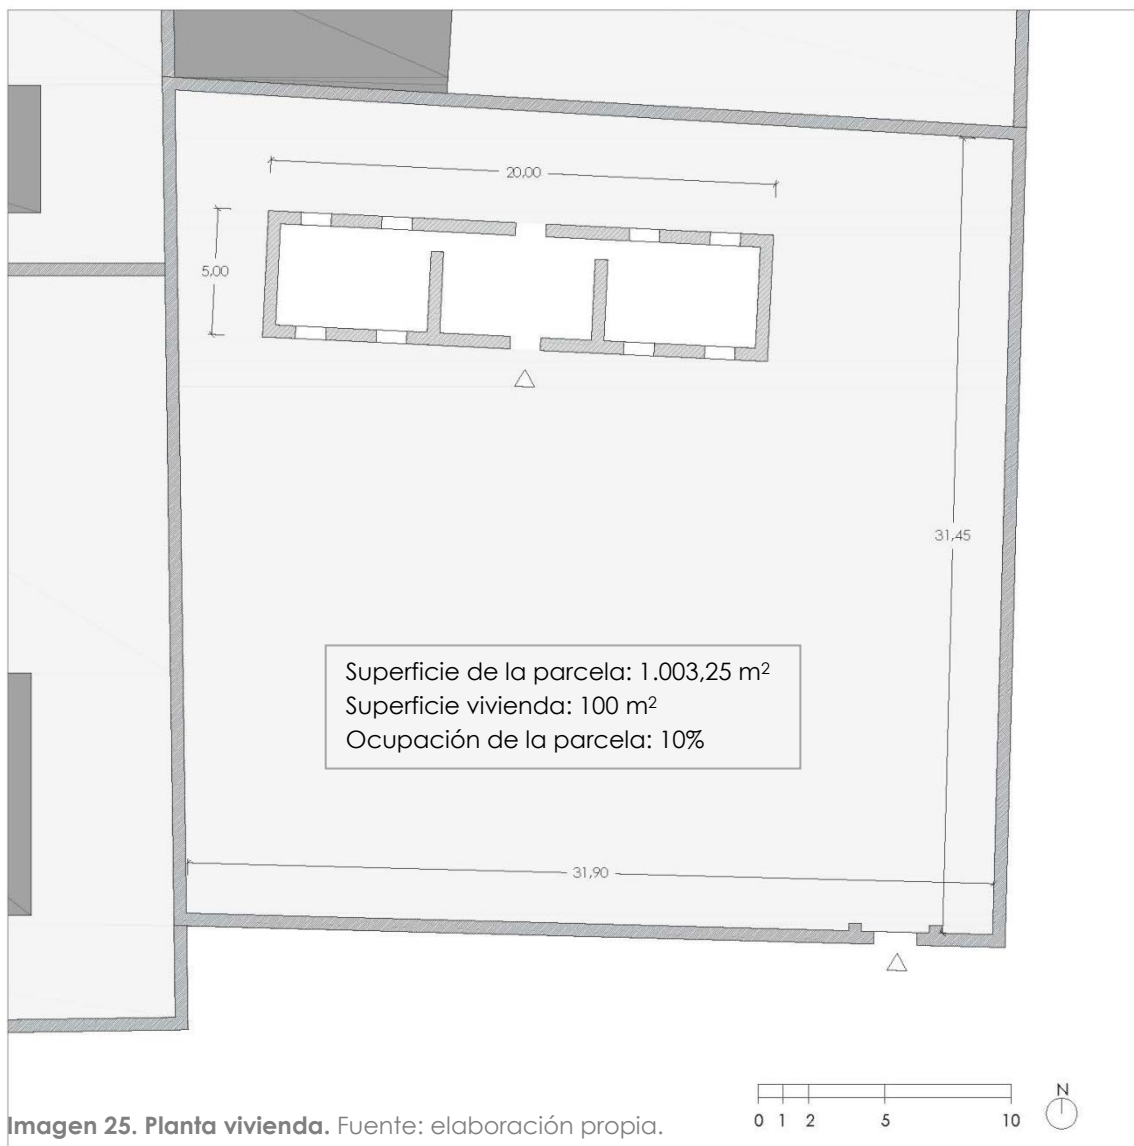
Planta vivienda. Fuente: elaboración propia.
